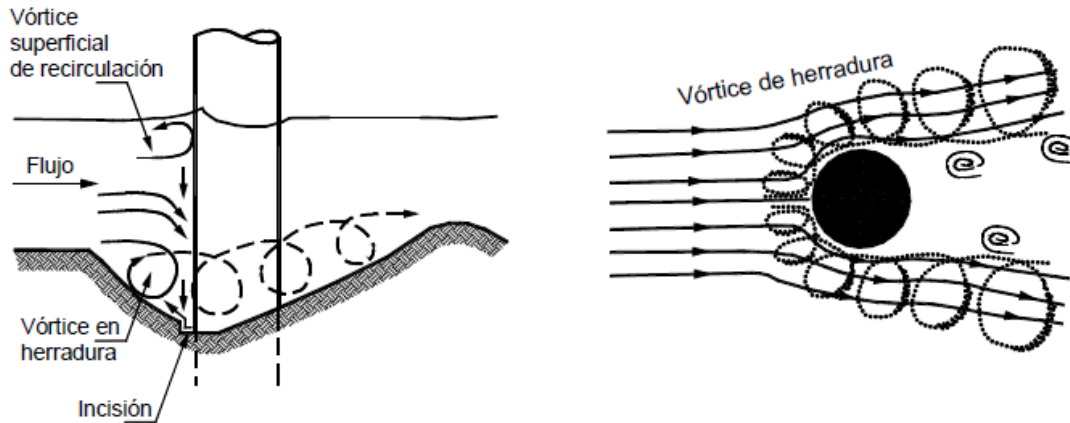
Diagrama en sección longitudinal del flujo alrededor de la pila de un puente y esquema en planta de un vórtice de herradura alrededor de una pila
